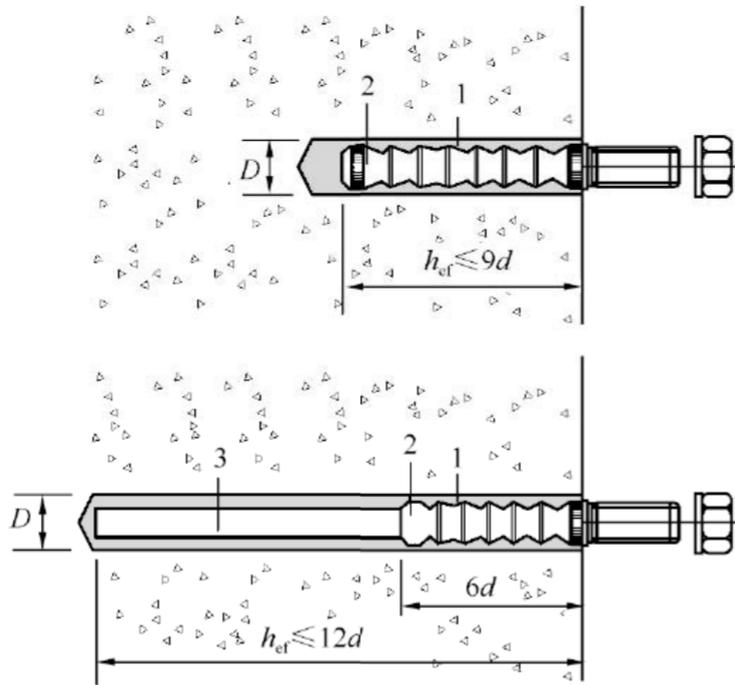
特殊倒锥形胶粘型锚栓
